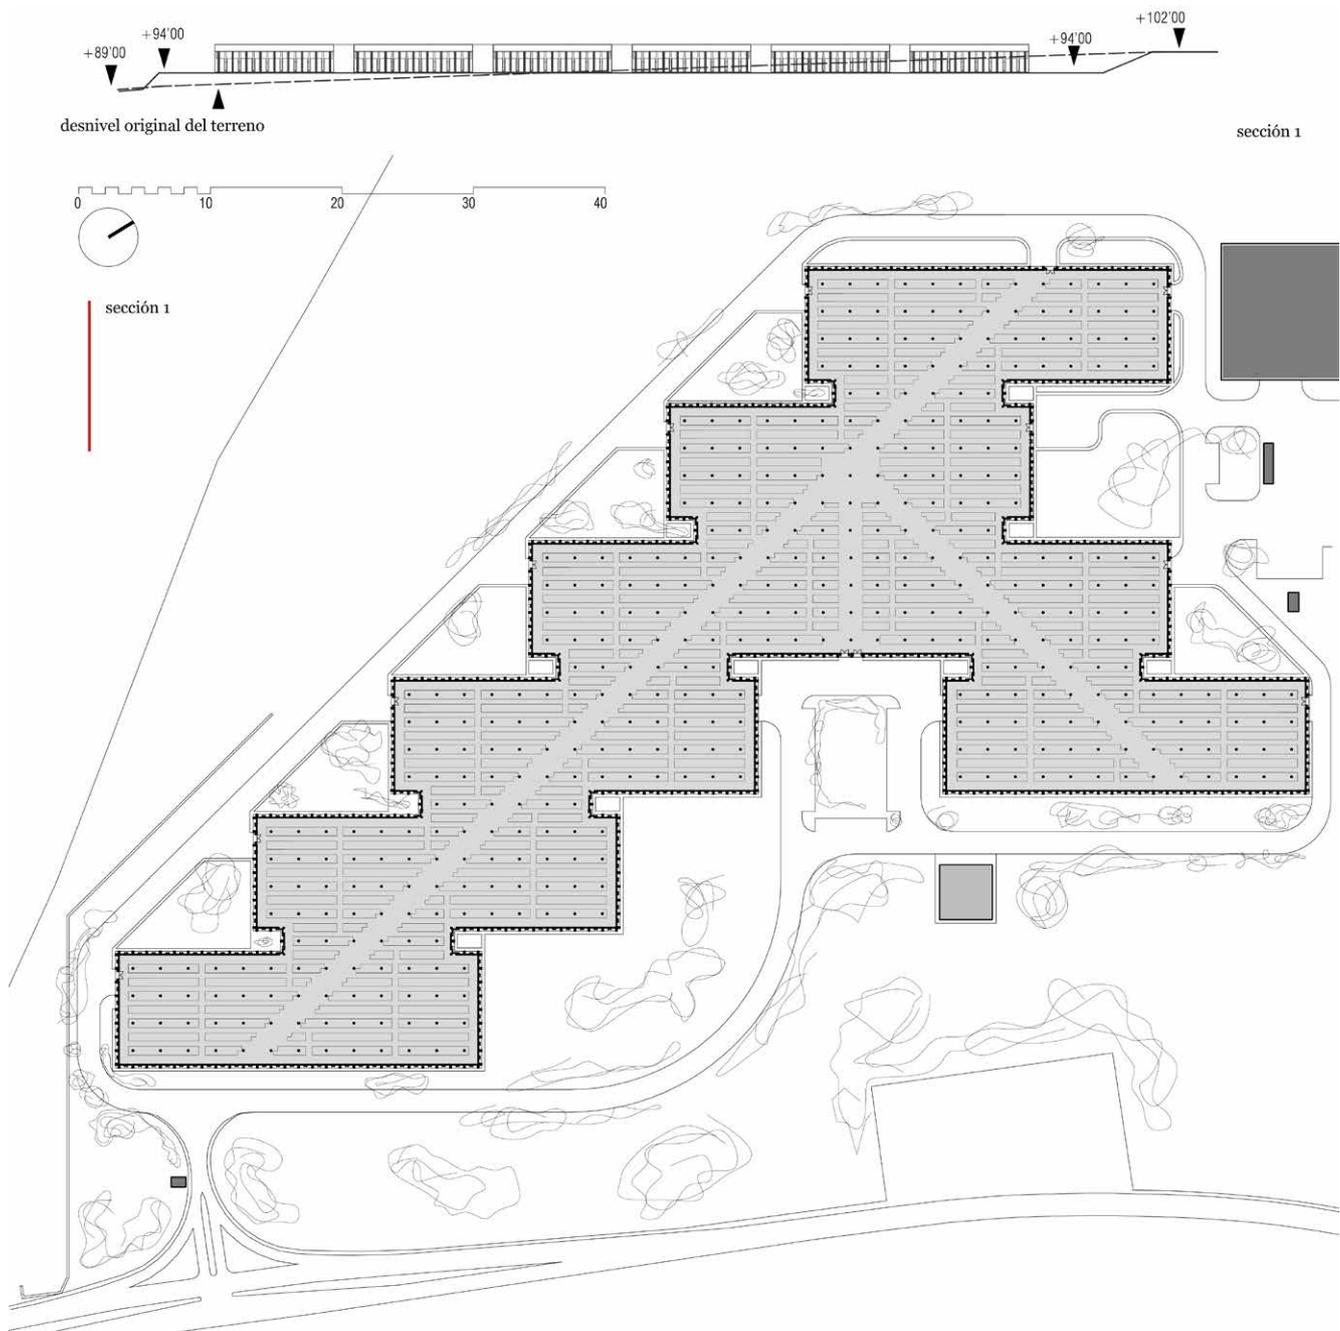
Planta y sección de las Bodegas Internacionales. Fuente: Elaboración propia.
